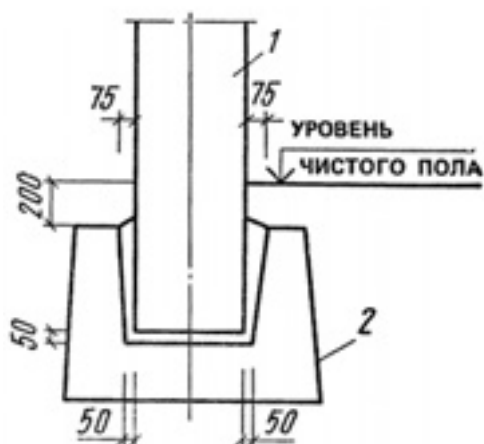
Узел сопряжения стеновой панели с лотковым фундаментом: 1 – колонна; 2 – лотковый фундамент
